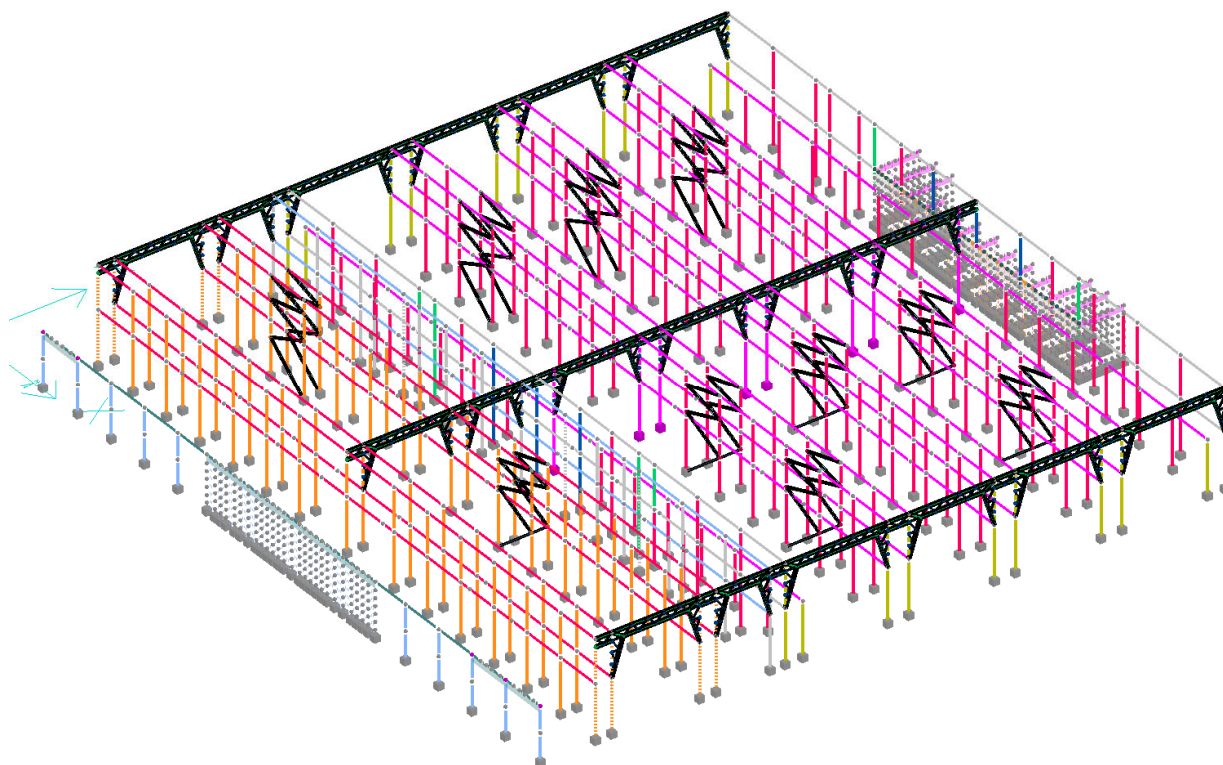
Disposizione delle strutture di controventamento in acciaio
